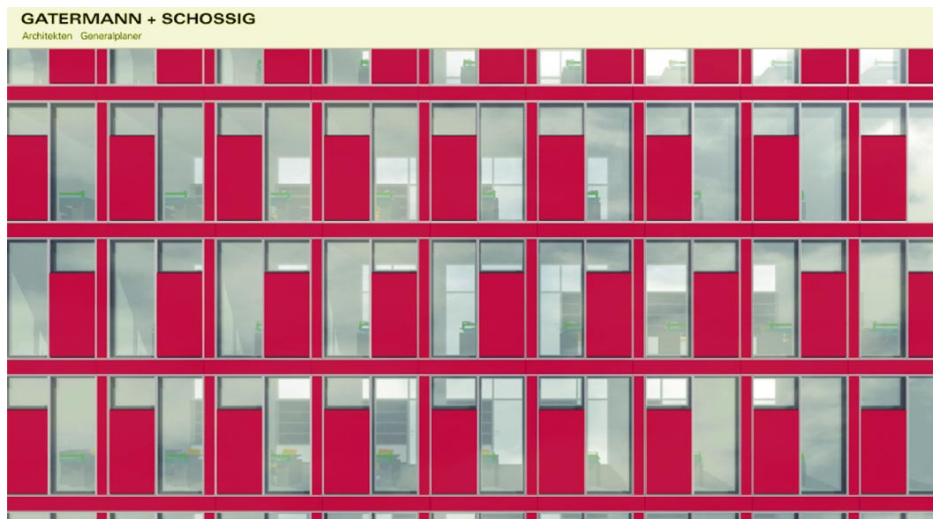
Interdisziplinäre Herausforderung: 867 i-modul Fassaden Elemente mit kompletter Fassaden- und TGA-Technik
